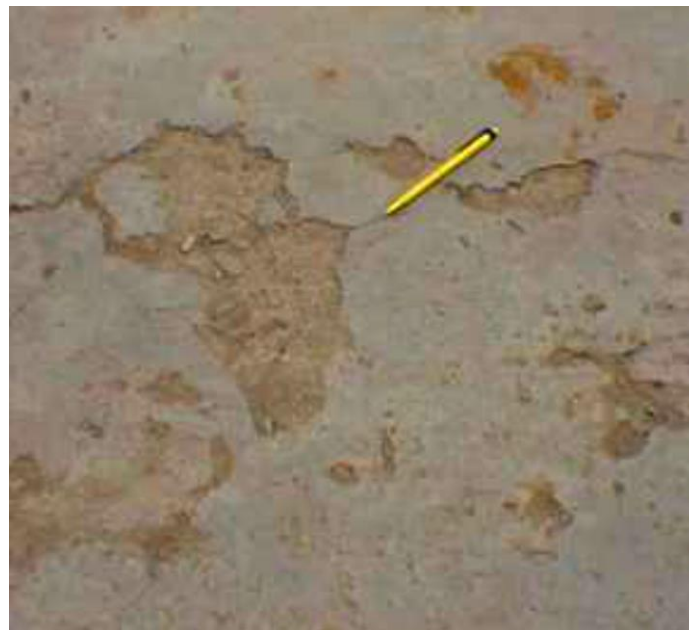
Descascaramiento en pavimentos rígidos.¹¹¹
